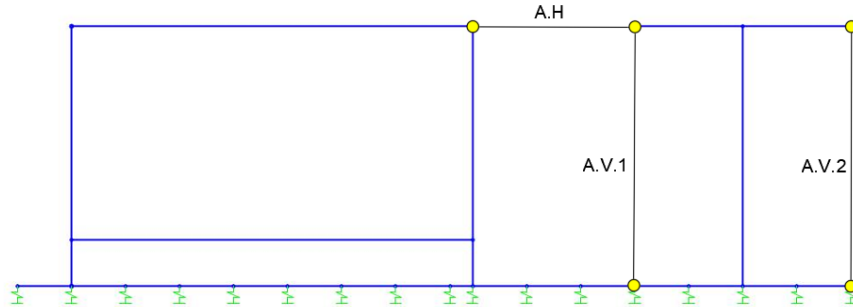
Elevación frontal sistema con viga de carga en el eje del espécimen.
